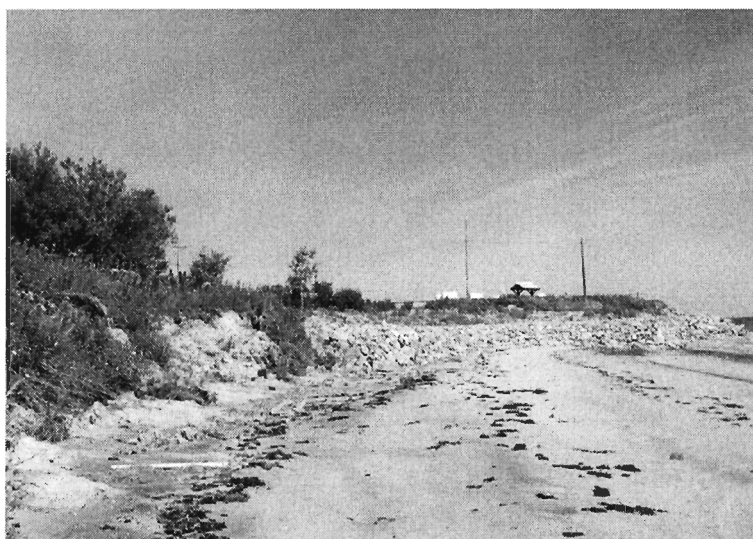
Enrochement d'une halte routière à Portneuf-sur-Mer
